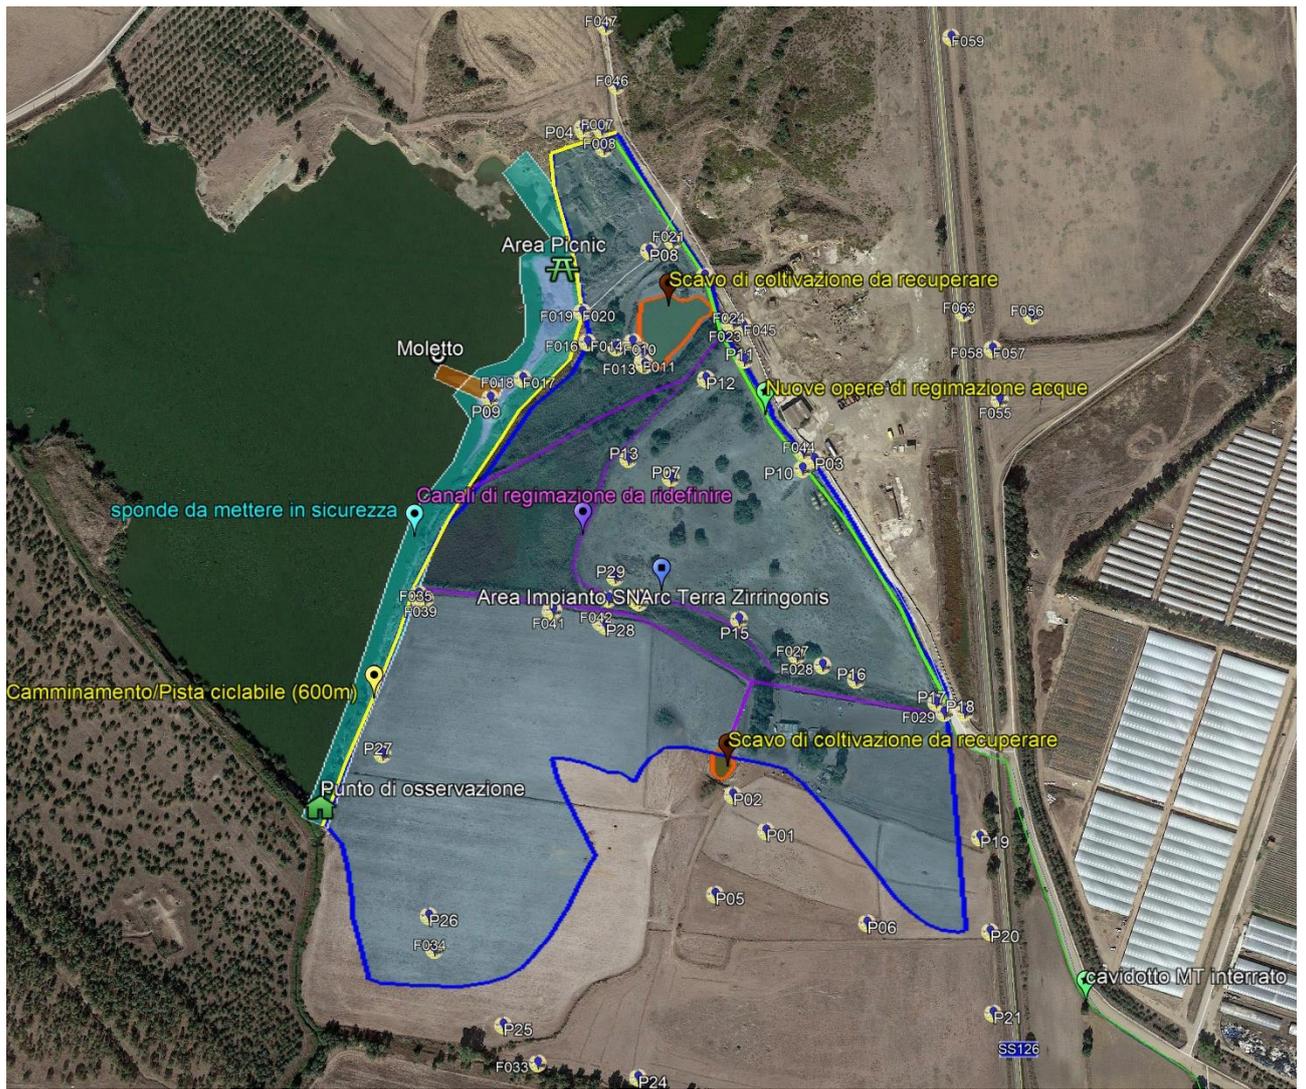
Planimetria del piano di recupero dell'area di cava su Google earth.
